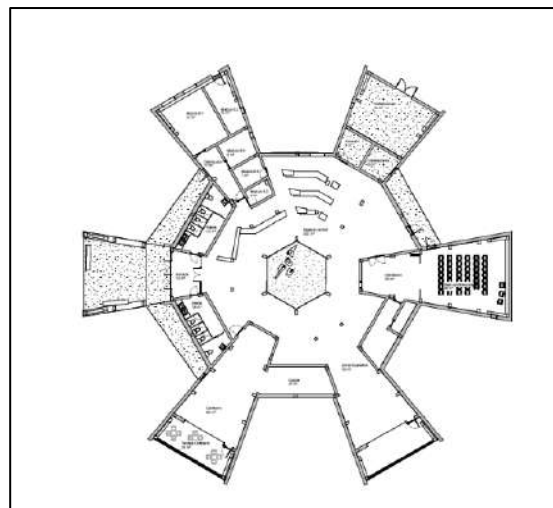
Planta del edificio. Fuente: Elaboración propia.
